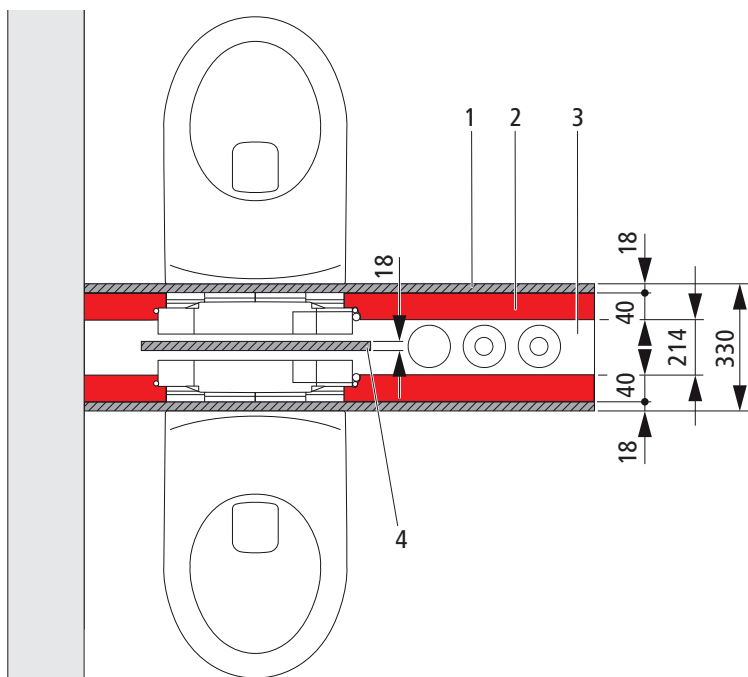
Vista dettagliata sezione parete divisoria 330 mm
